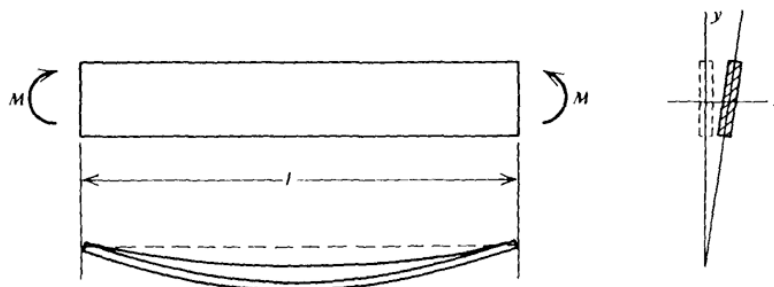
Instabilità di una trave inflessa (Park e Paulay, 1975).
